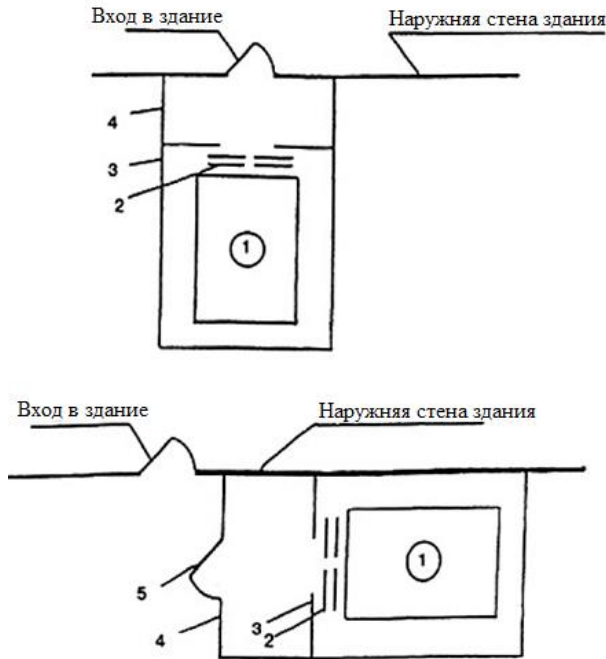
Установка лифта для пожарных у наружной стены здания:
